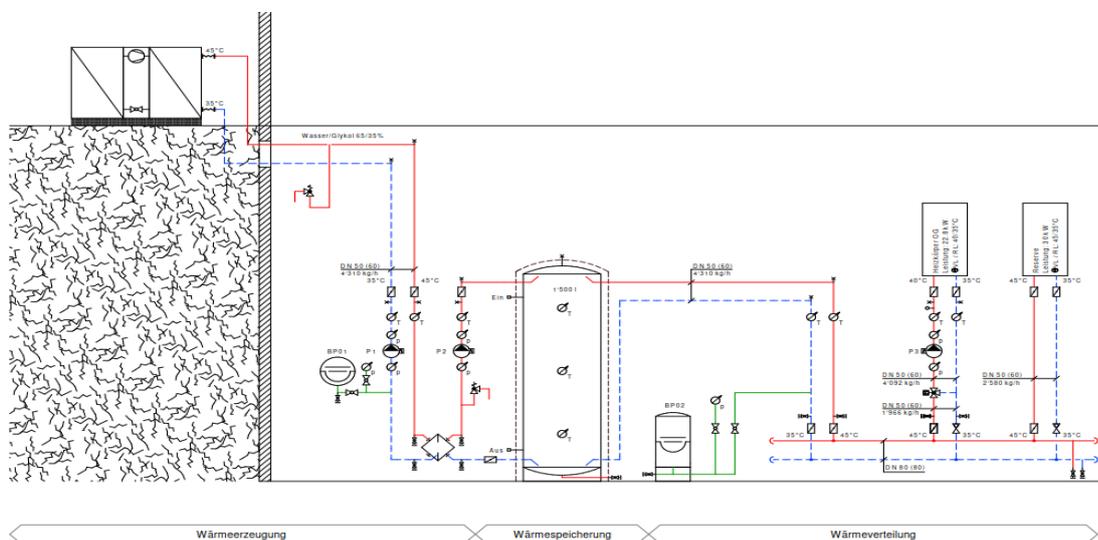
Schéma de principe de l'installation de chauffage Source : Ing. Büro Brunner Haustechnik AG, Wallisellen
